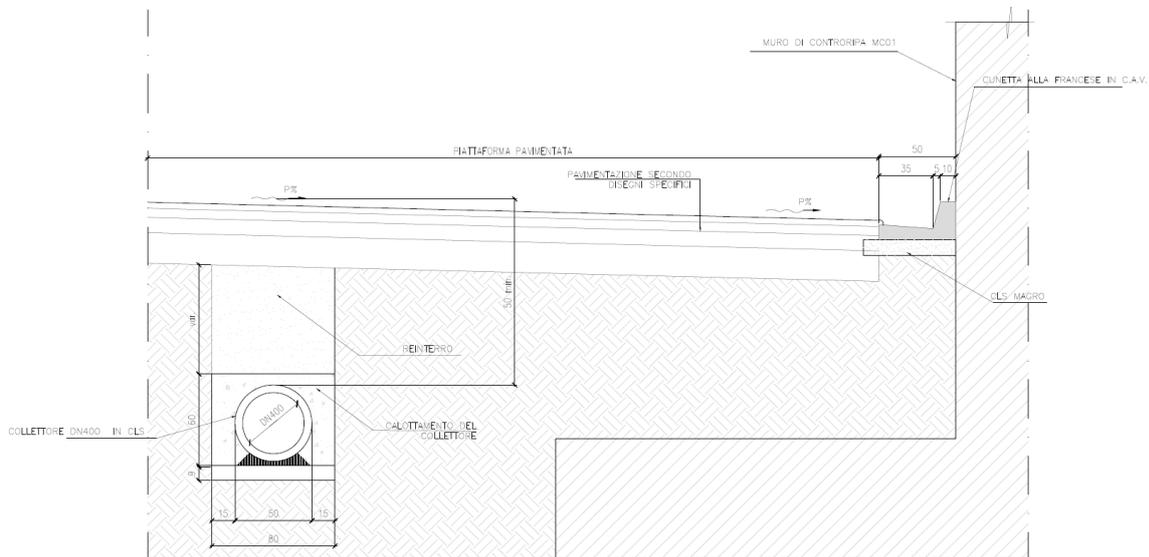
Sezione tipo cunetta lungo Asse "B".
